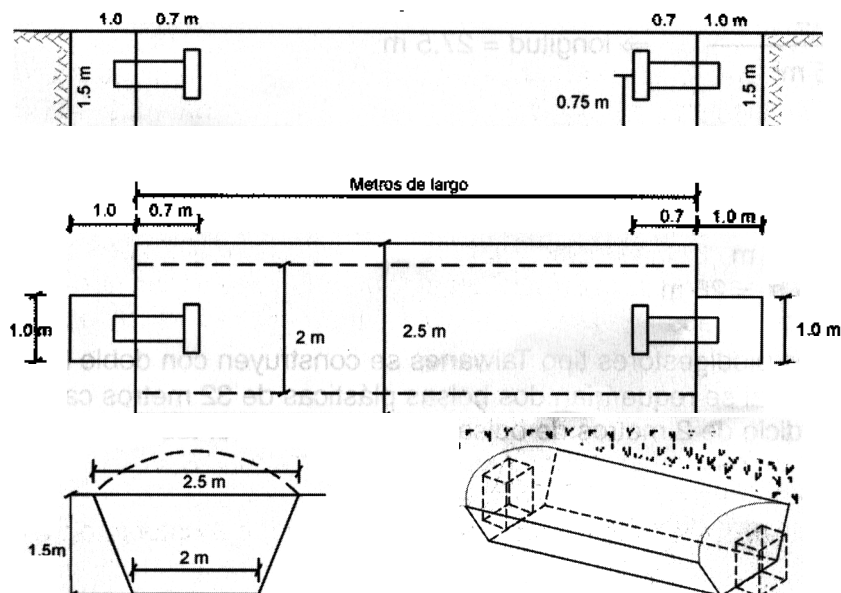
Plano Biodigestor tipo taiwanés o balón plástico
